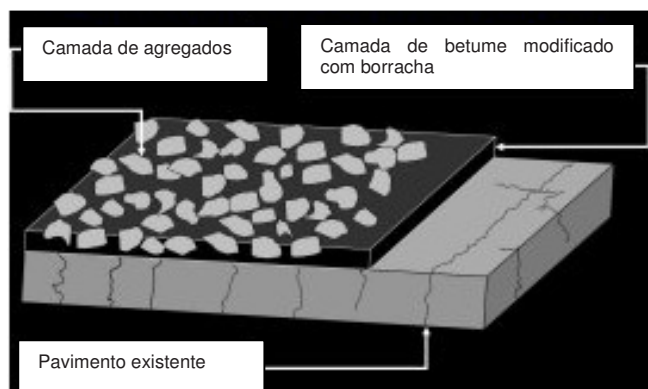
Esquema de membrana impermeabilizante de pavimentos fendilhados - SAM adaptado de (Clemson, 2014)
